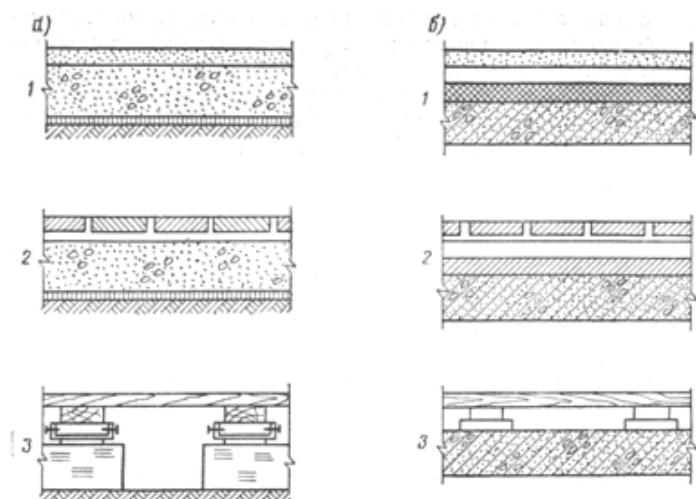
Полы гражданских зданий: а – на грунте: 1 – цементные; 2 – плиточные; 3 – дощатые по лагам; б – по перекрытиям: 1 – монолитные; 2 – плиточные и паркетные; 3 – дощатые
